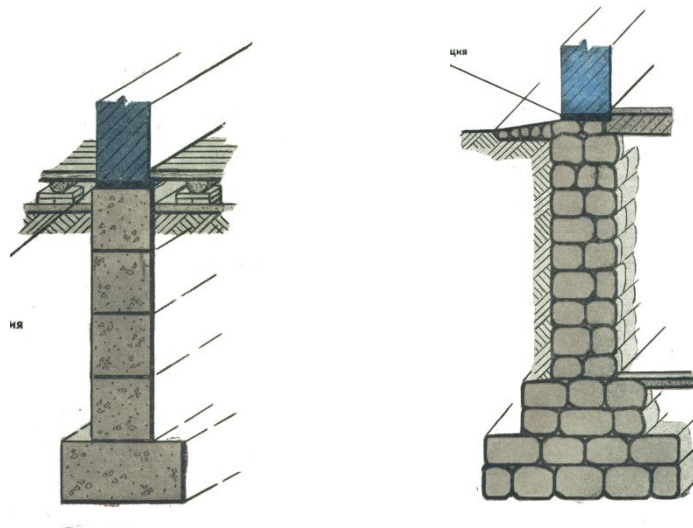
Стрічковий фундамент зі збірних блоків (а) та фундамент з бутової кладки (б)
